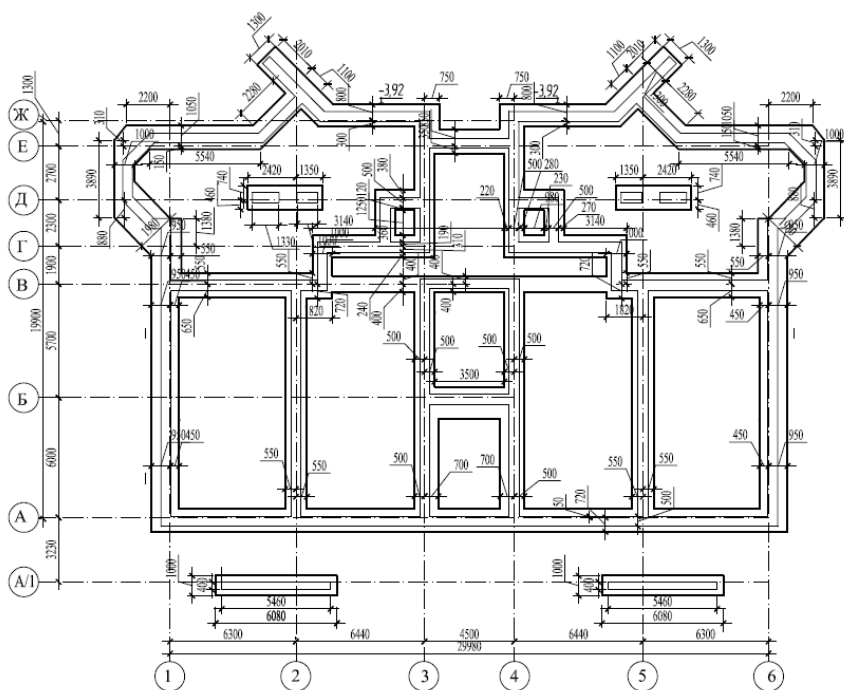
Приклад плану адміністративної будівлі на нульовій відмітці
